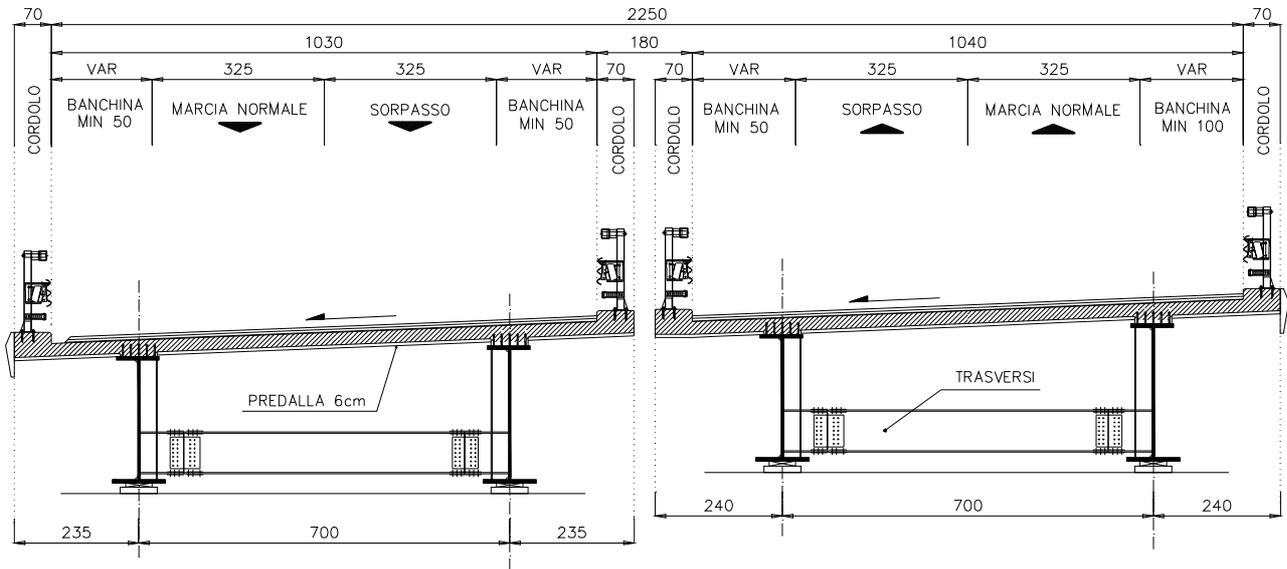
Sezione tipo impalcato Scavalco FFSS
